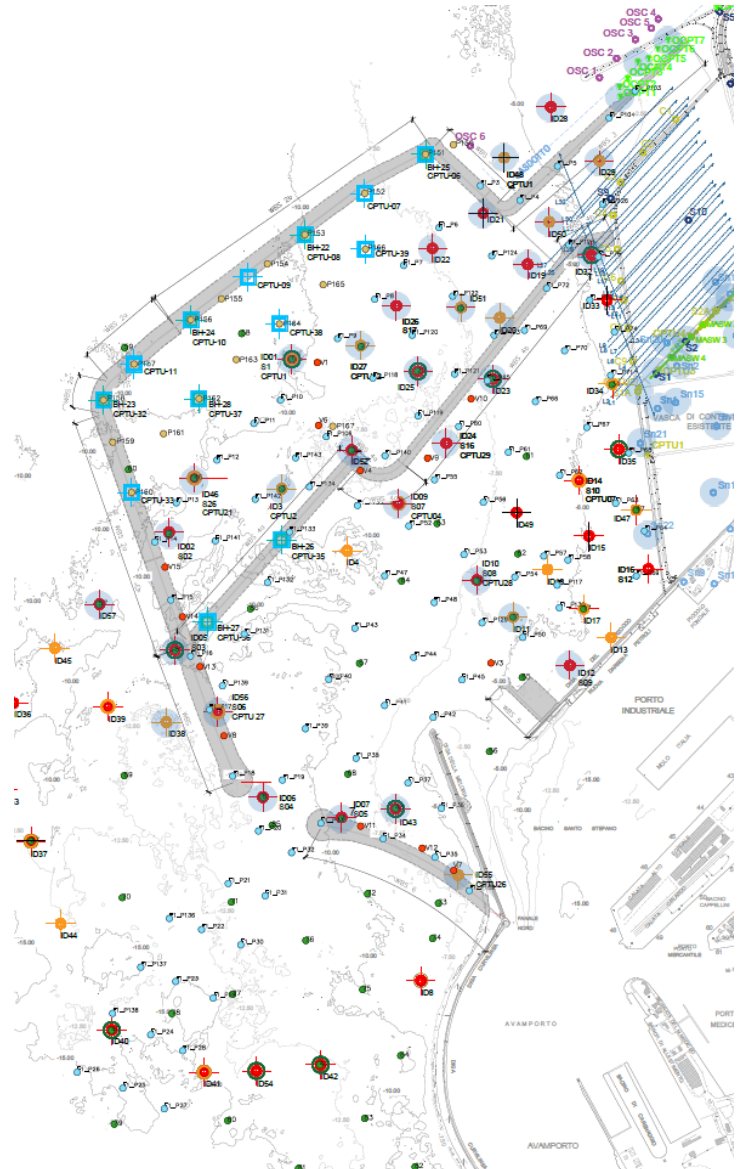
Estratto dalla "Planimetria delle indagini" 1233_PD-B-001
